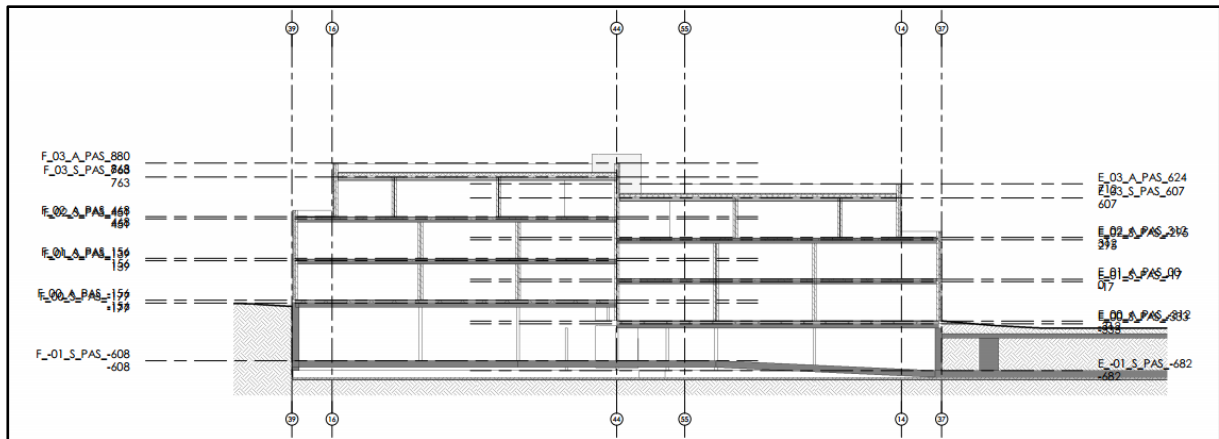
Uitsnede uit inplantingsplan: ondergrondse parking blok A. (bron: NERO nv)
